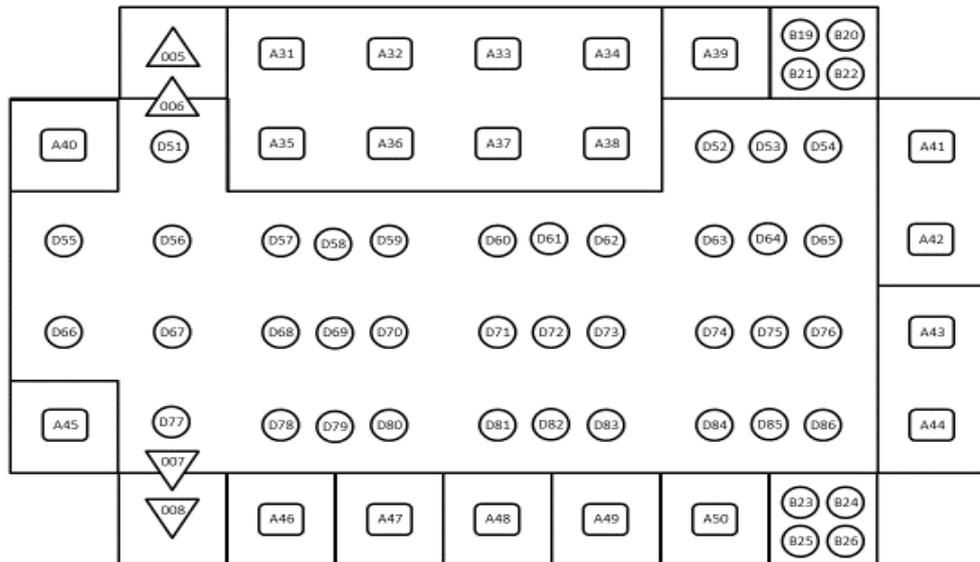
Denah Lampu Lantai Dasar Gedung SC
